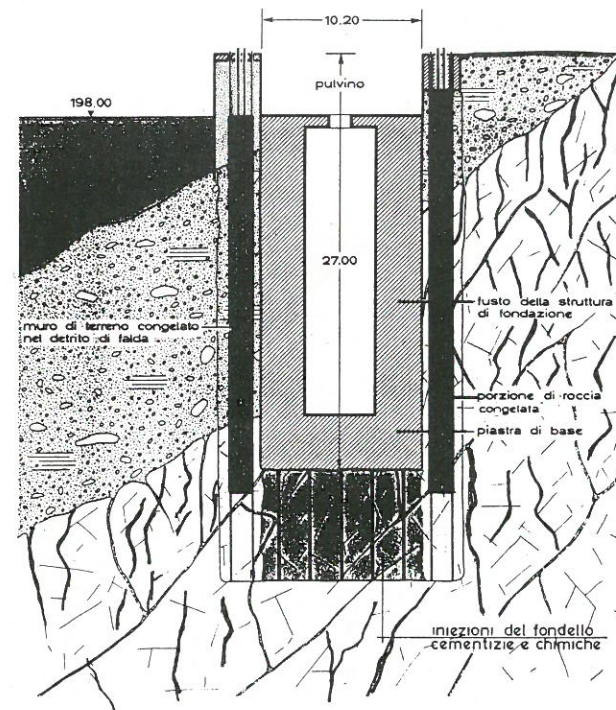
Lo scavo protetto dal congelamento lungo tutte le pareti e da iniezioni (cementizie e di resine fenoliche) sul fondo
